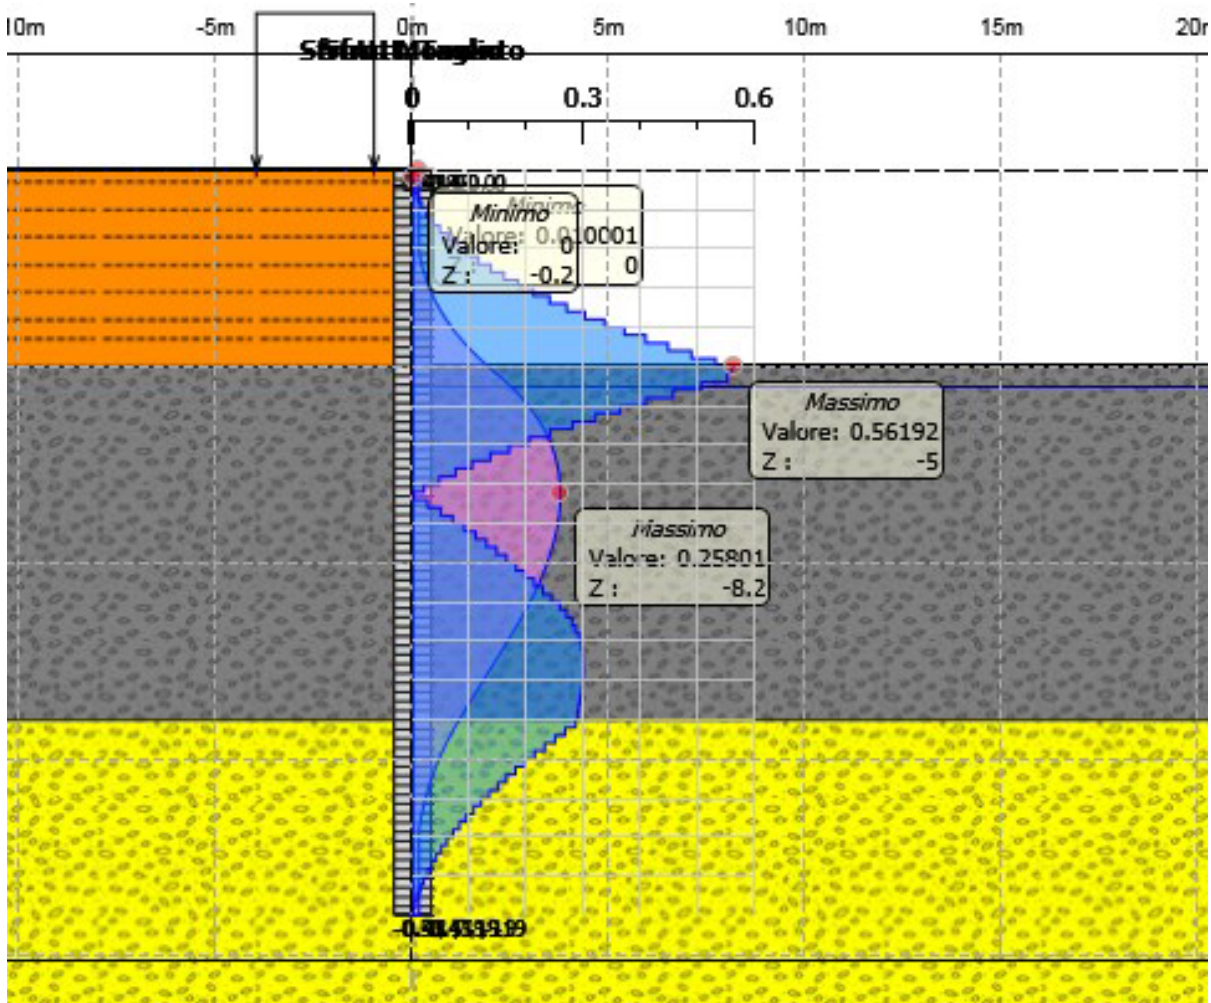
Spalle - coefficiente di sfruttamento sugli elementi strutturali – Verifica SLU (A1+M1+R1)
